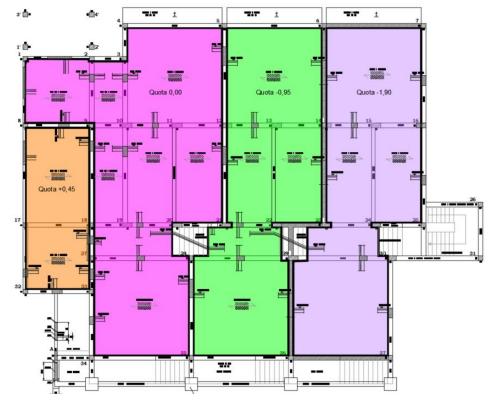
Pianta piano terra (progetto strutturale - 1975) con evidenziati i diversi livelli di quote
